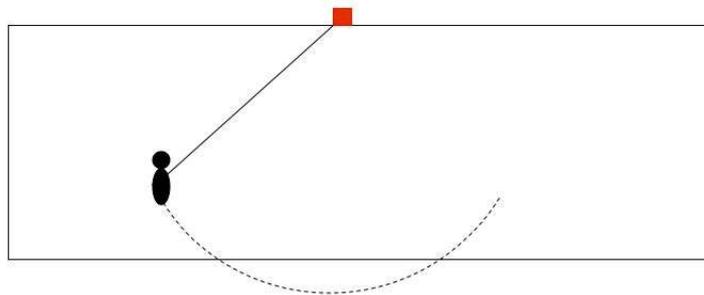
Sólo con el anclaje dibujado no es posible trabajar en retención. Si la cubierta tiene pendiente o el trabajador tiene una distracción, puede existir caída perimetral.
